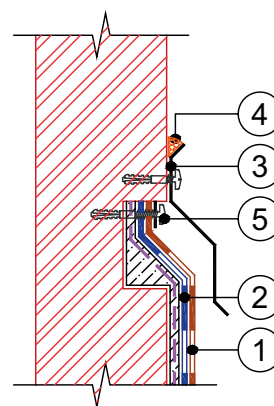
Примыкание кровли к стене с заведением края водоизоляционного ковра в штрабу
